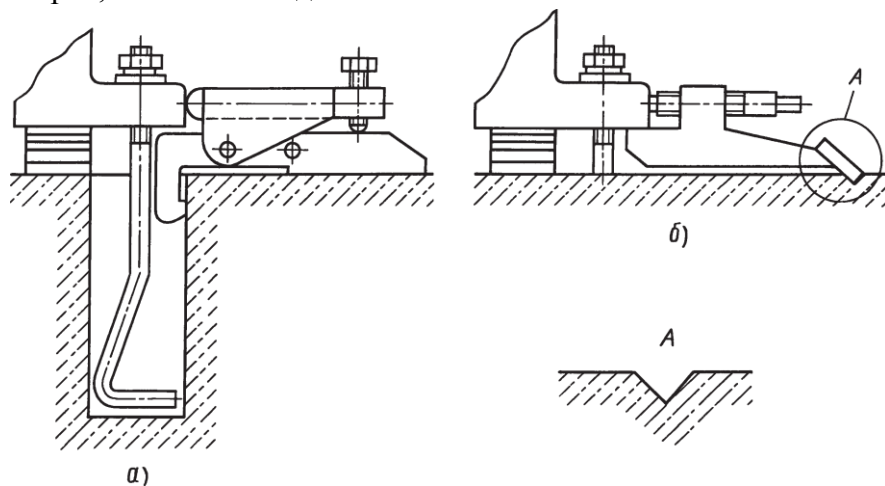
Приспособления для выверки оборудования в плане: а — рычажно-винтовые; б — с упорным винтом
